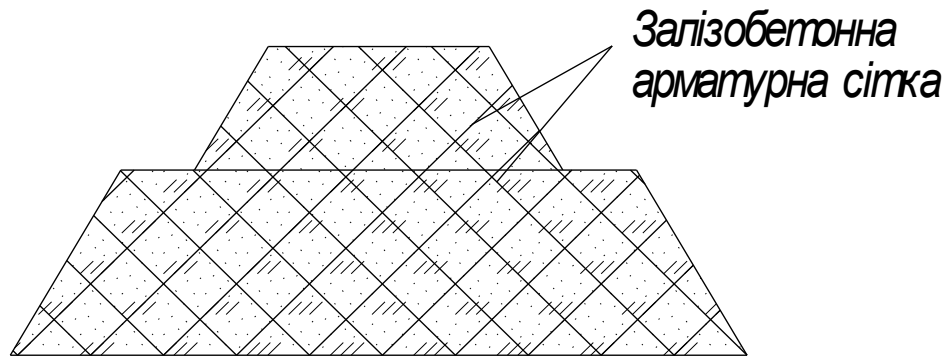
Екранування відвалу залізобетонною сіткою
